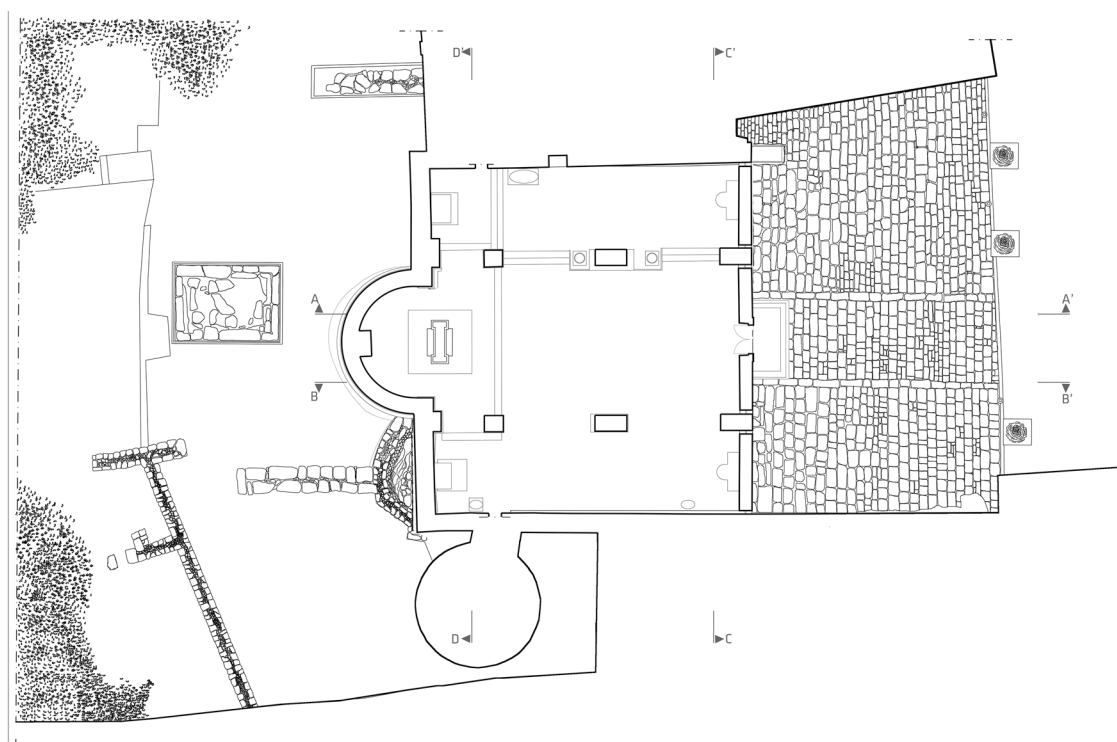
La planimetria della chiesa e dell'area archeologica della Pieve a Socana. (Archivio Autori)
